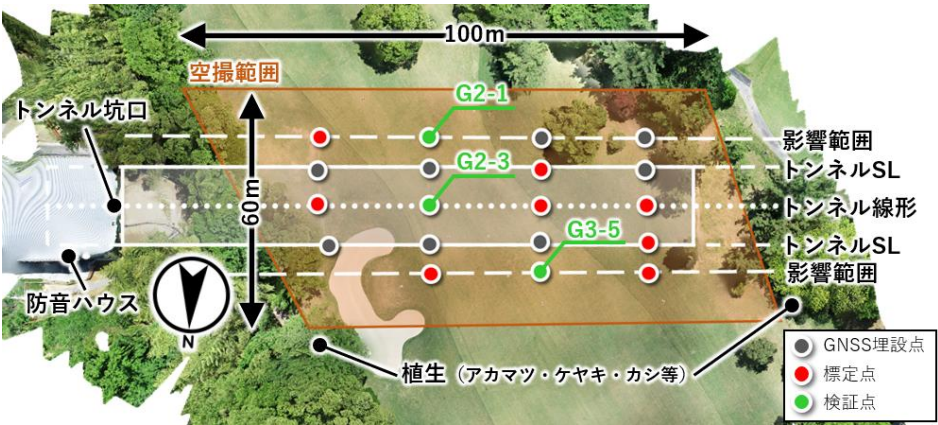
トンネル平面図，空撮範囲および対空標識設置状況
